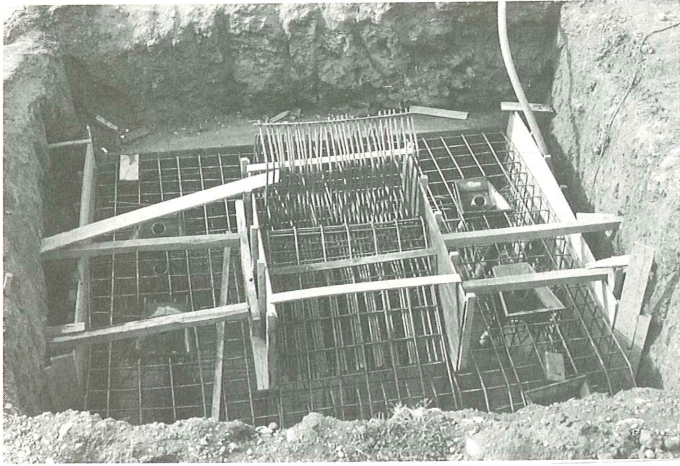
Ferralla de zapata. Anclajes cables al terreno.
